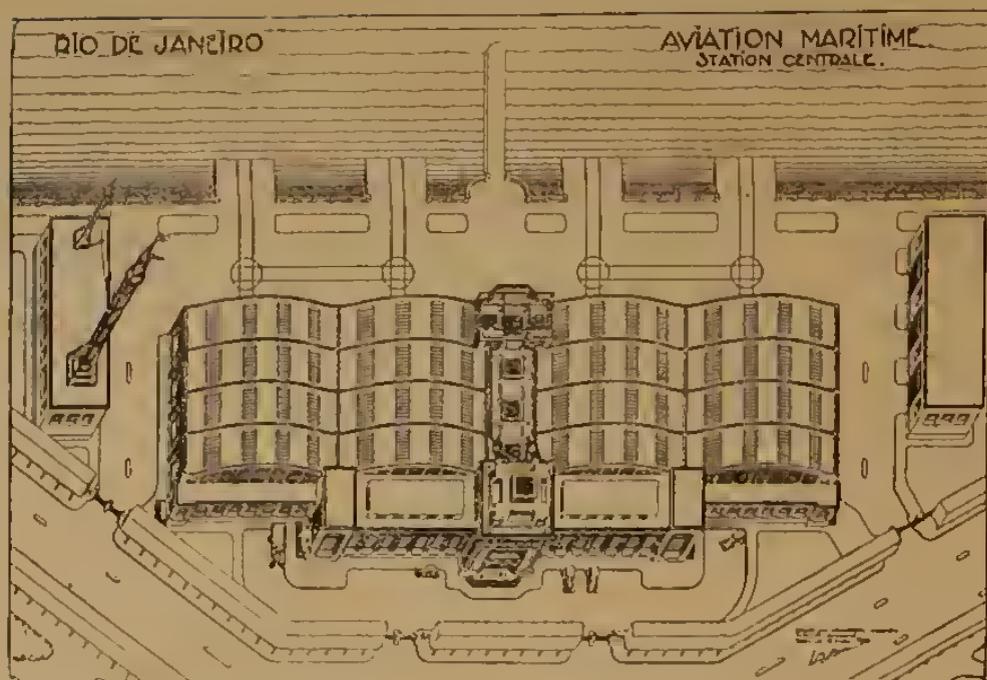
Projecto da estação central de hydro-aviões (Calabouço).
